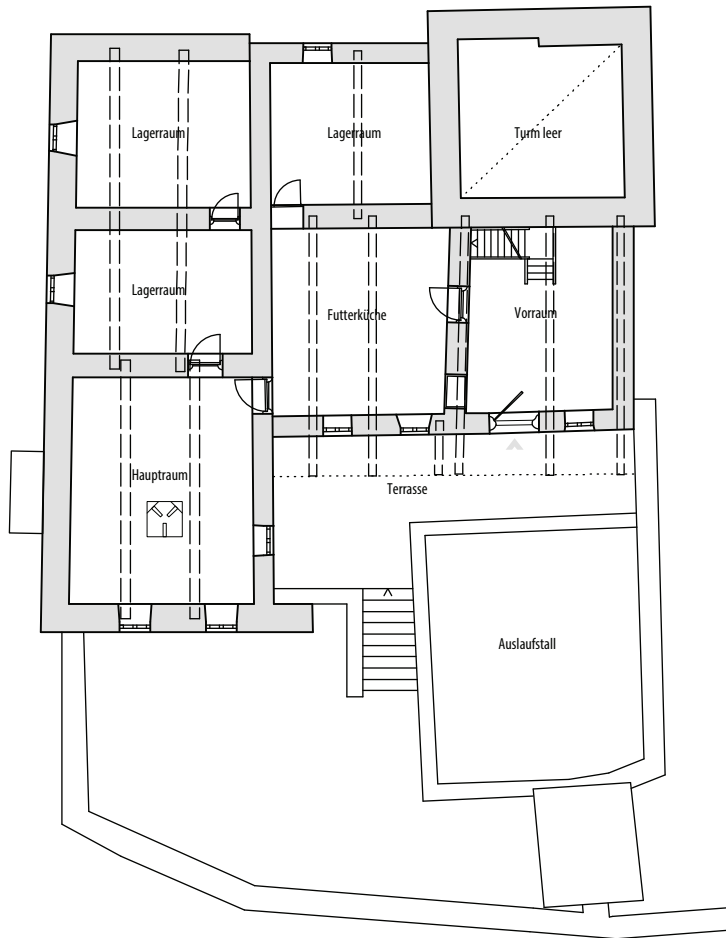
Grundriss erstes Obergeschoss. Turmhaus in Zhonglu bei Danba.
